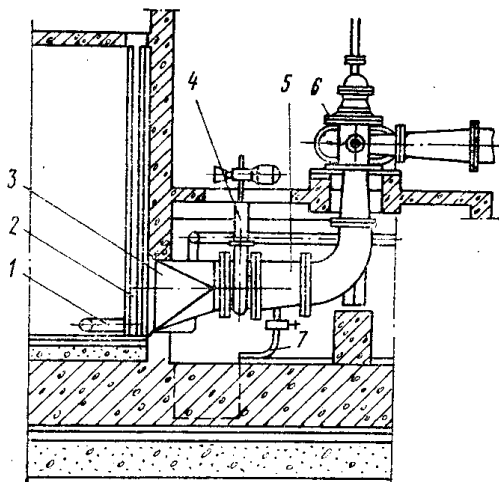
Устройство всасывающего трубопровода большого диаметра
